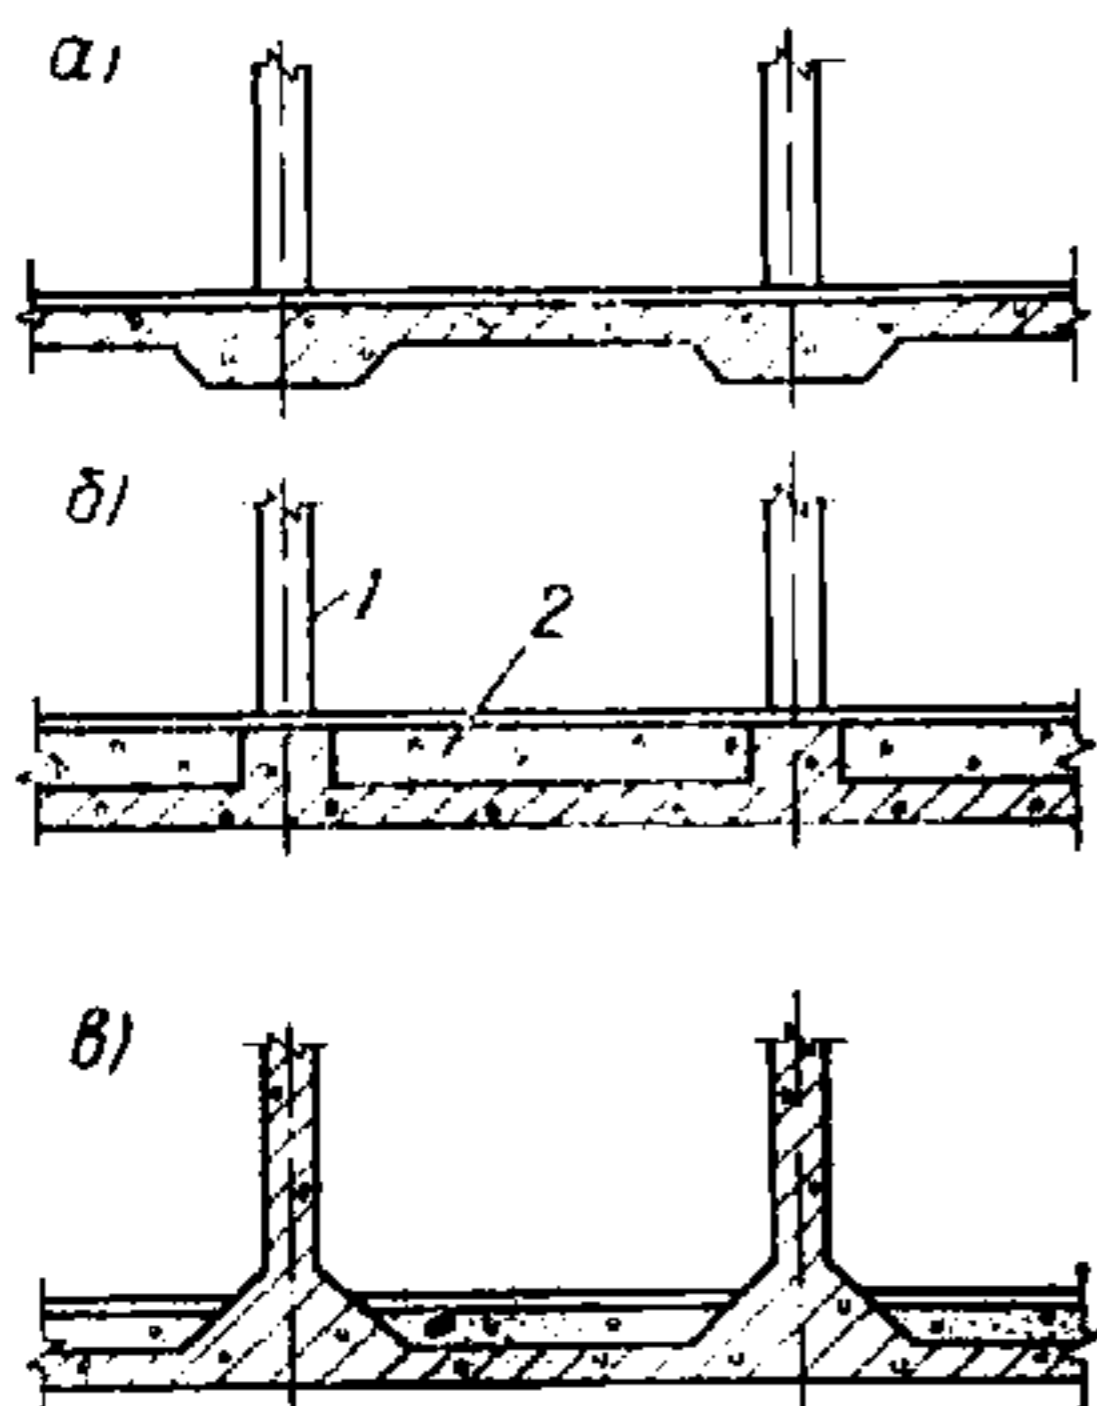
Конструктивные решения сплошной фундаментной плиты
